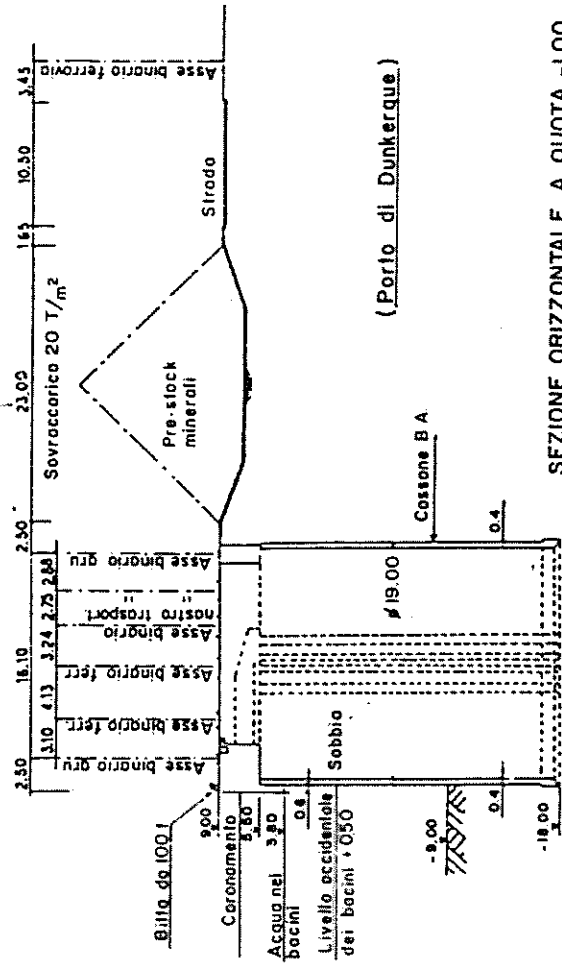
CASSONI AUTOAFFONDANTI A PIANTA CIRCOLARE
